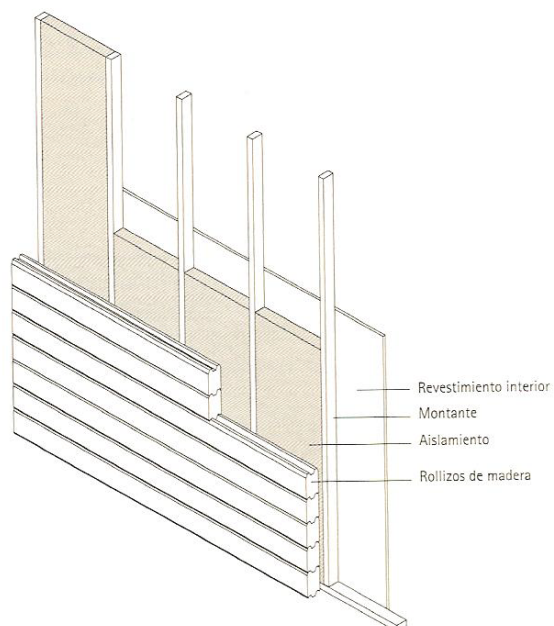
Detall constructiu d'un sistema d'acabat interior [2].
